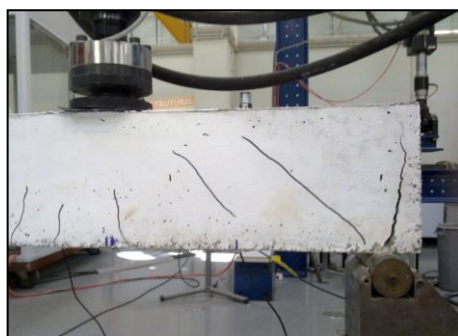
Fissuração do recobrimento num topo da viga V5
